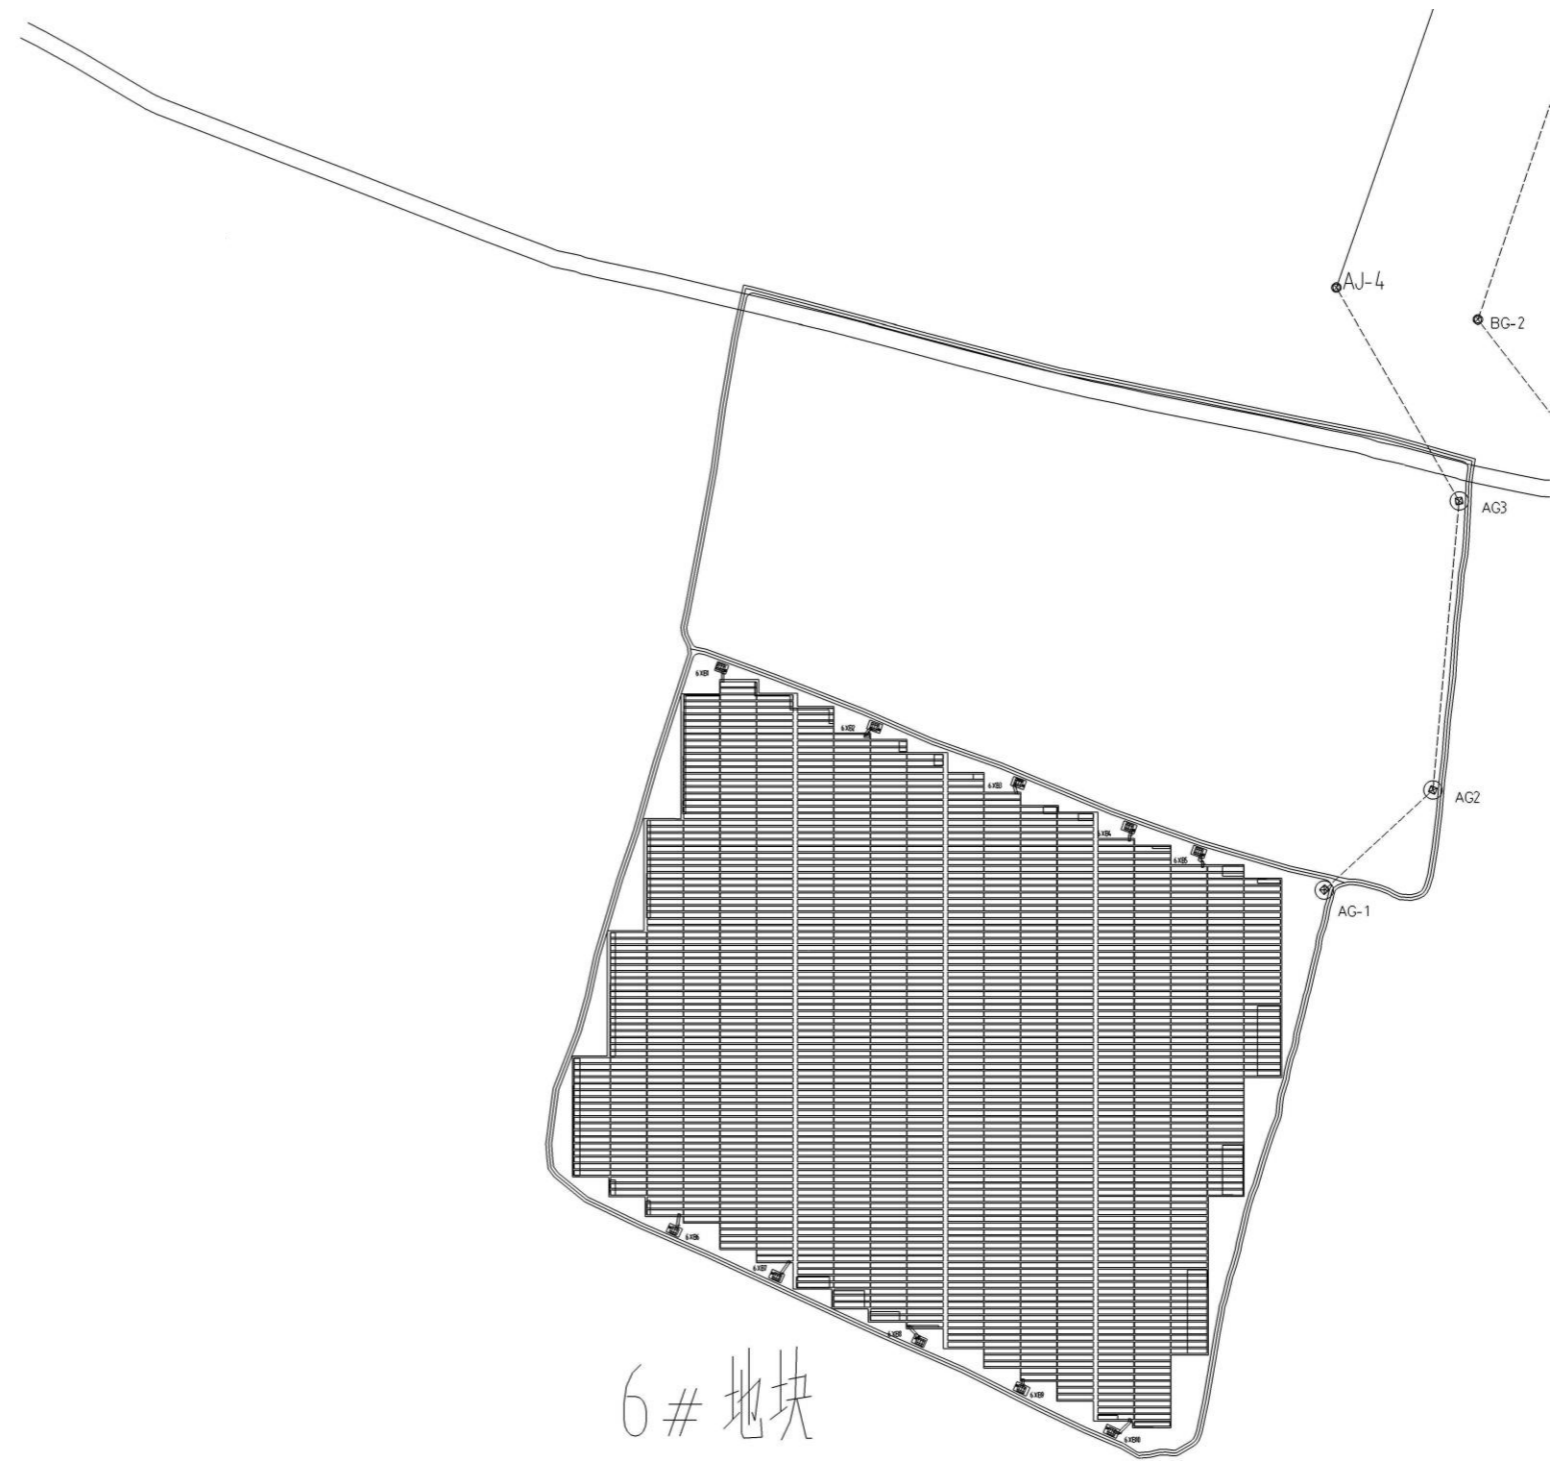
光伏区平面布置图（茭一围仔南边滩咸围）
